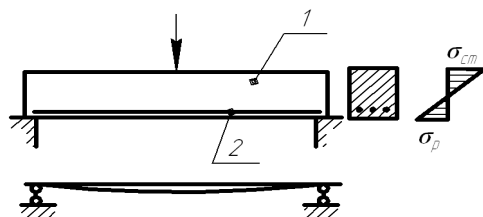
Схема роботи арматури в залізобетонному елементі: 1– бетонний елемент; 2– арматурний стержень
